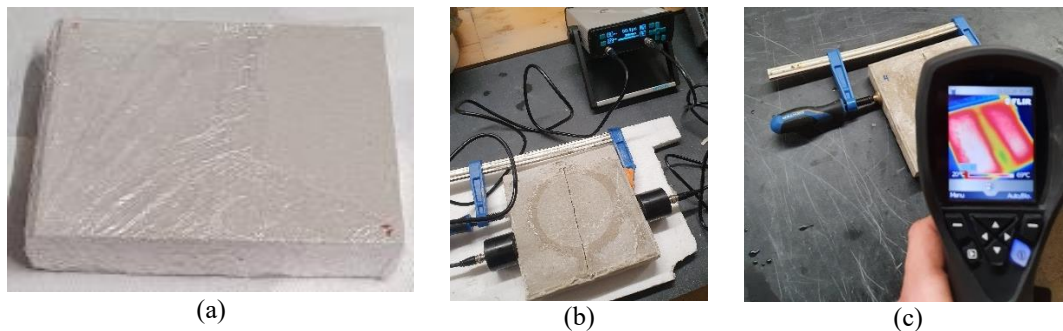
Tratamento das fissuras por biocimentação e monitorização do tratamento: a) impermeabilização das lajetas com película plástica aderente; b) medição de ultrassons; c) ensaio de termografia.
